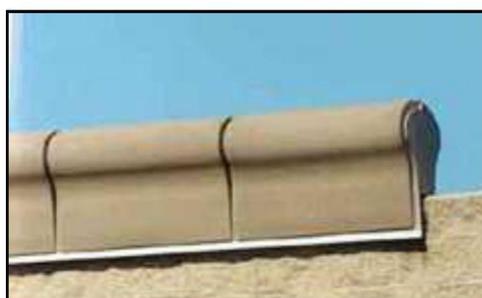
Внешний вид верхней части шумозащитных экранов
